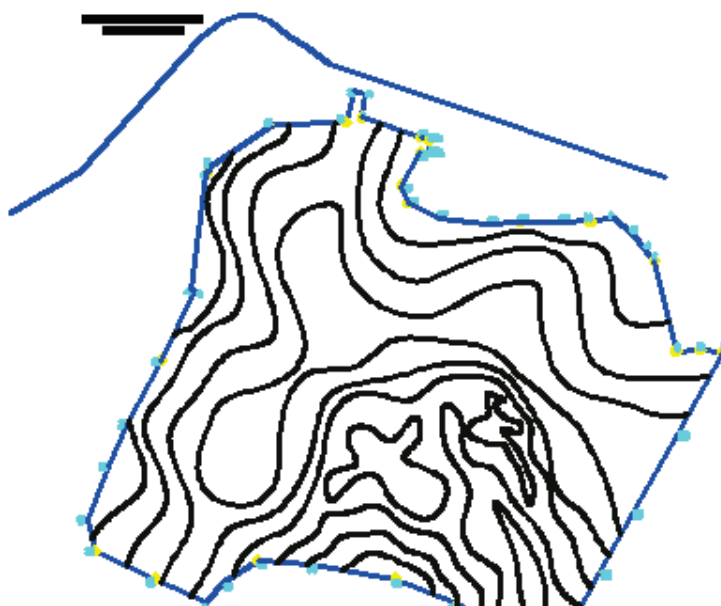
, Plano Topográfico del proyecto, Fuente Planimetría del Proyecto
